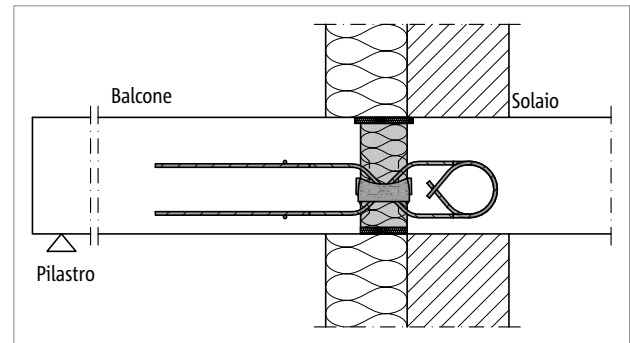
Schöck Isokorb® T tipo QL-VV: raccordo con sistema di isolamento a cappotto
